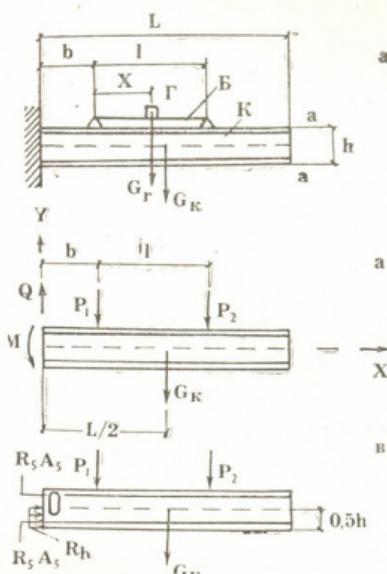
К примеру расчета максимального веса груза, воспринимаемого железобетонной консольной балкой без разрушения
